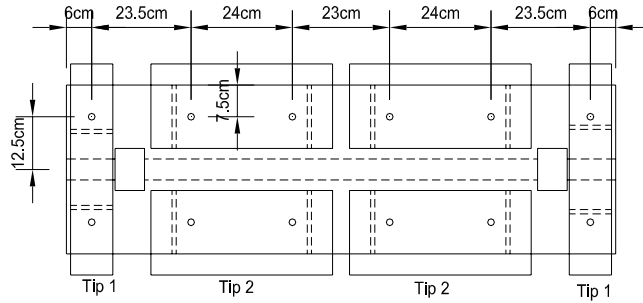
Betonarme çerçeve zayıf kiriş detayları
